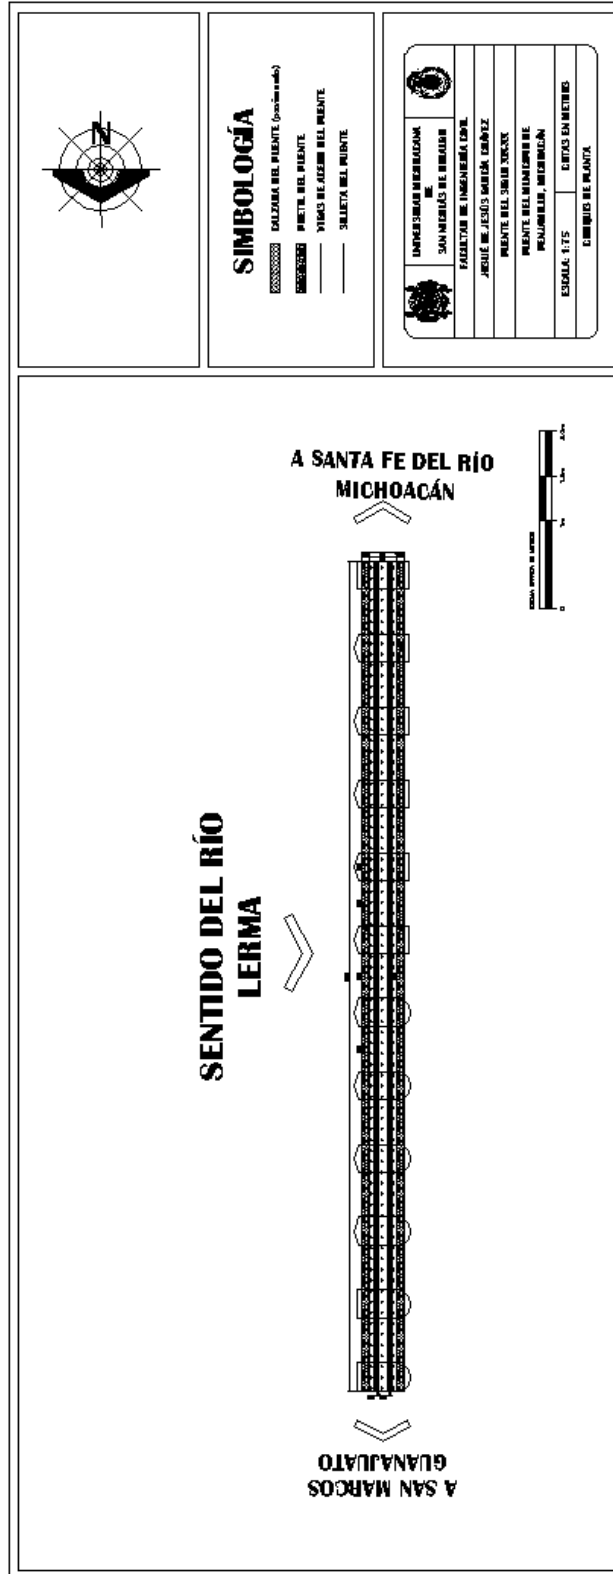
Croquis en planta del puente ubicado en el Municipio de Penjamillo, Michoacán.
